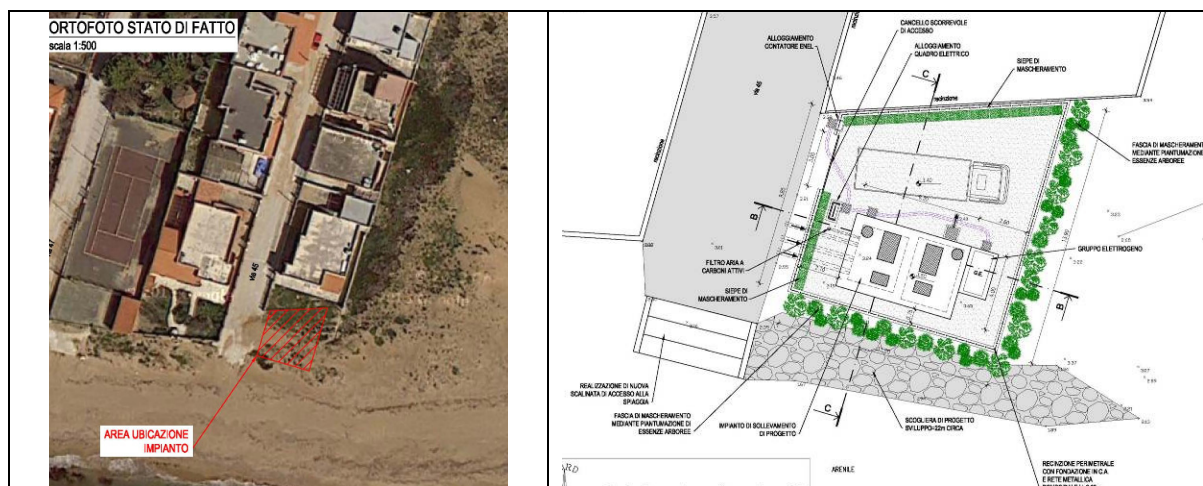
Localizzazione territoriale dell'impianto e planimetria con le sistemazioni previste.
